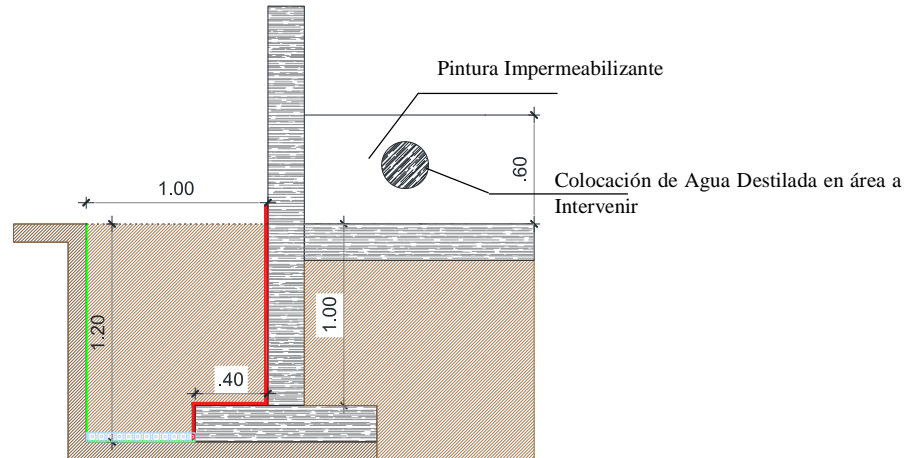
Detalle de colocación de pintura impermeabilizante (S/E)
